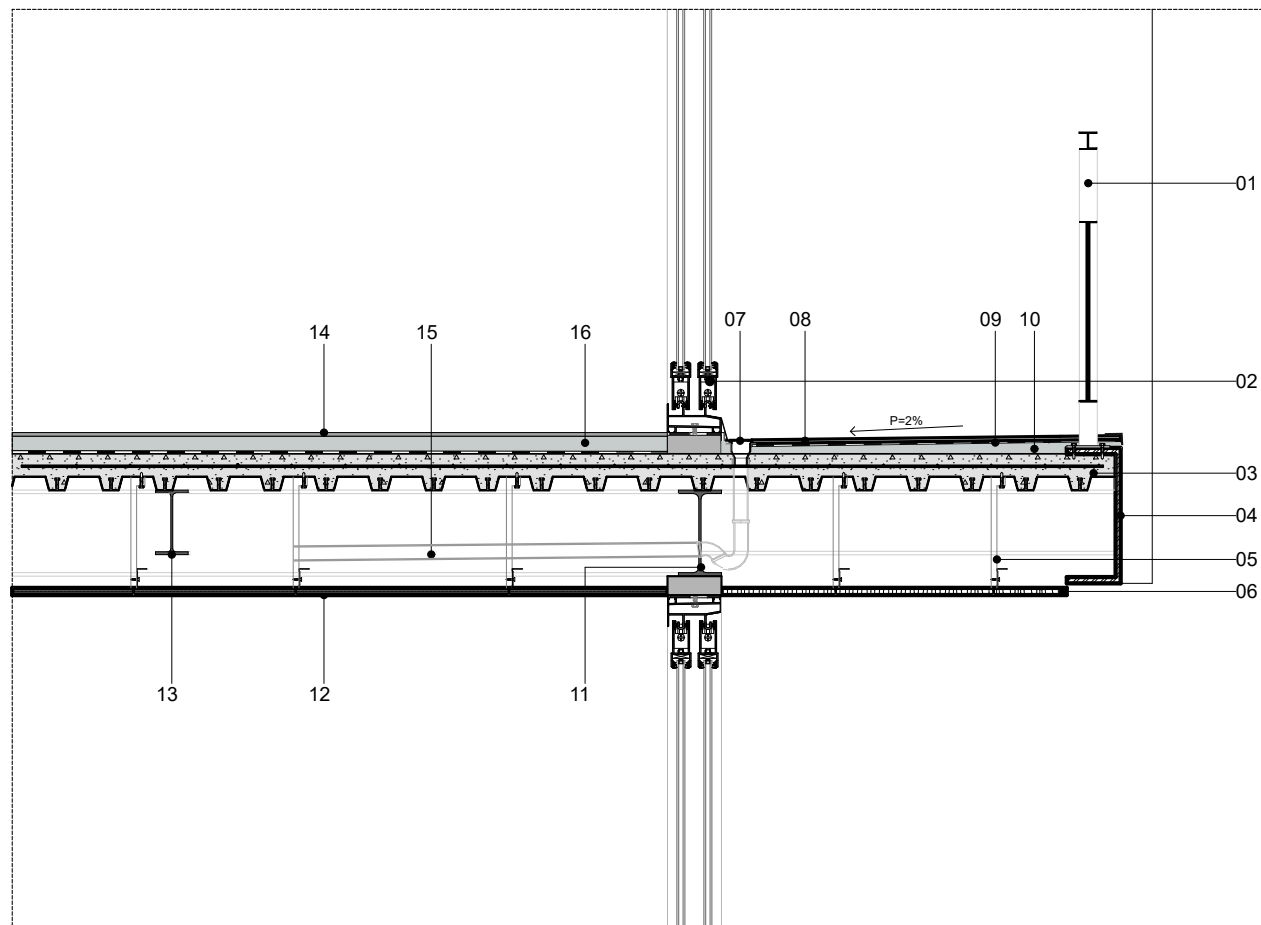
Detalle constructivo 01 Fuente: Elaboración Propia
